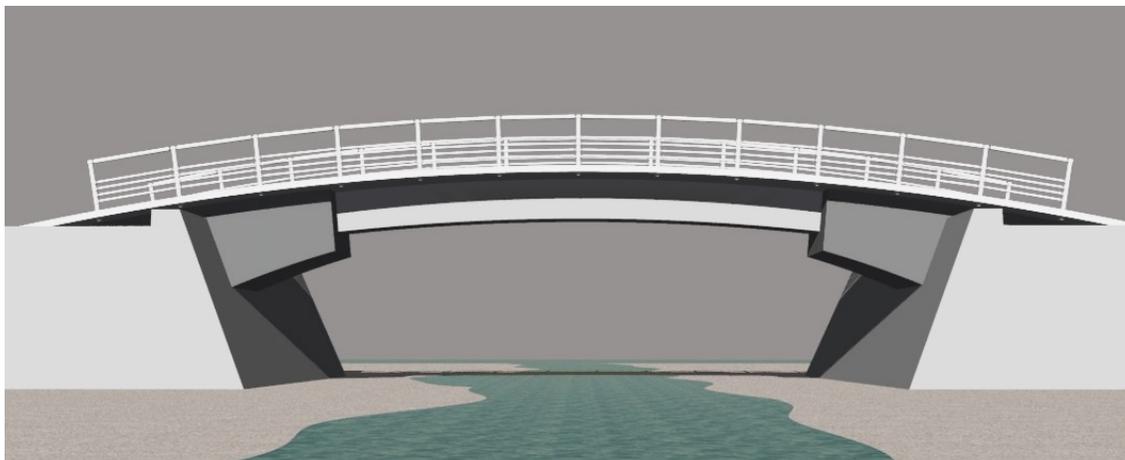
Ponte em concreto proposta no projeto e não executada.
